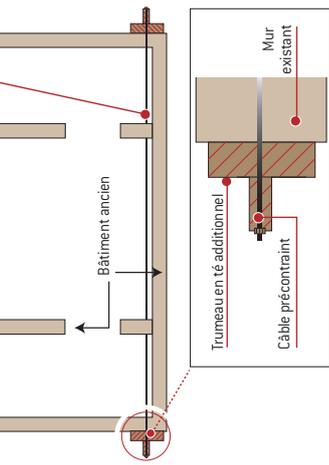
Exemple de renforcement par ajout de murs en béton à l'extérieur + serrage par précontraint (vue en plan)
